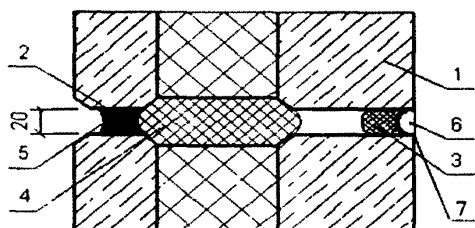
Горизонтальный стык трехслойных железобетонных панелей стен.
